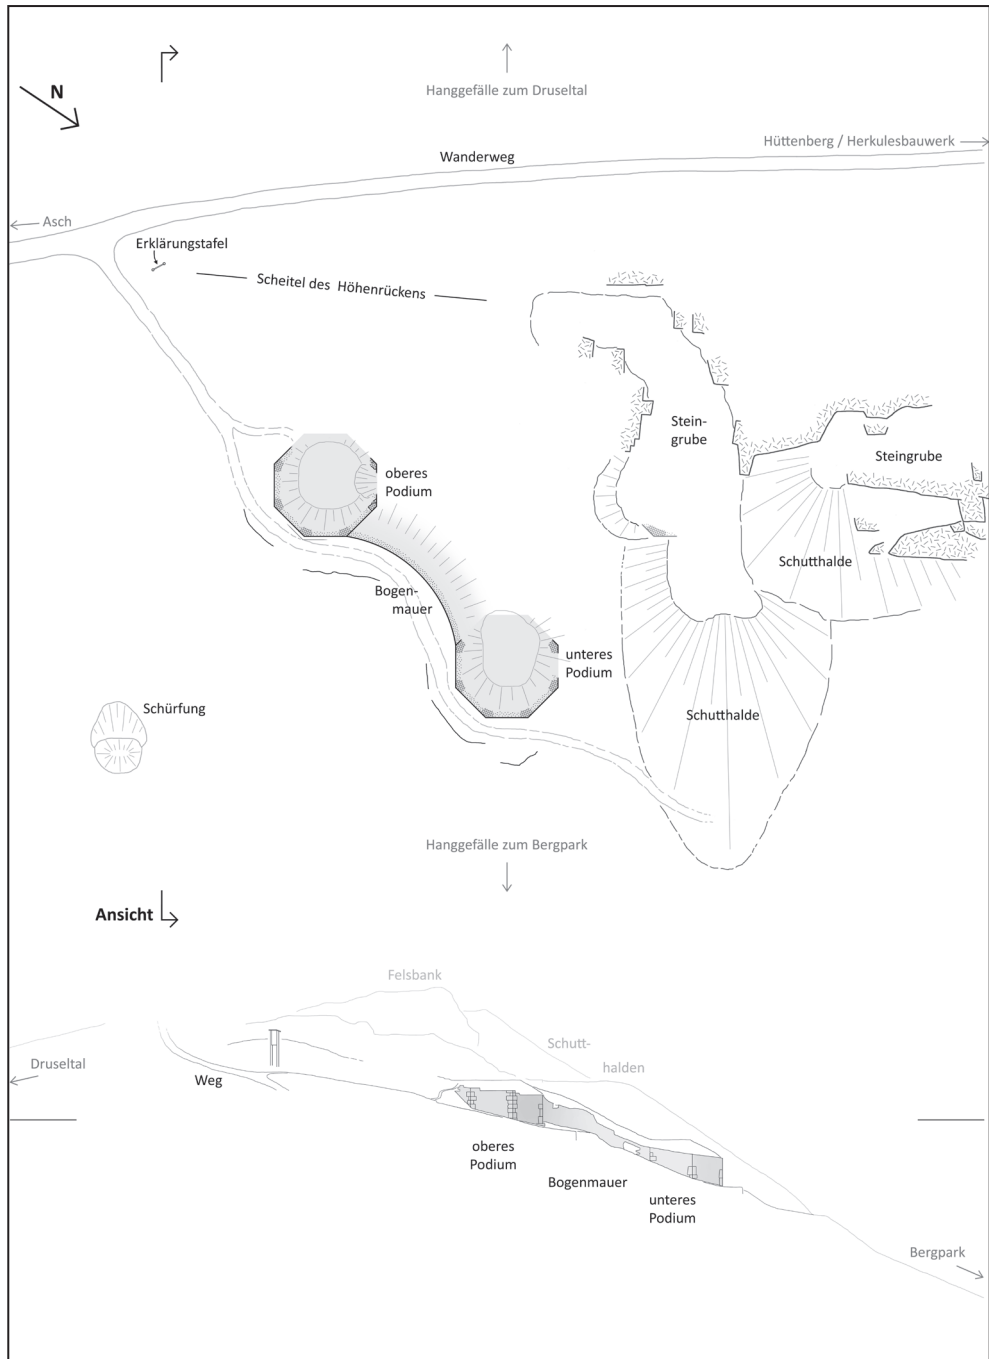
Der angetroffene Bestand in einem Grundrissplan und einer Ansicht von Südosten [Plan Stefan King]
